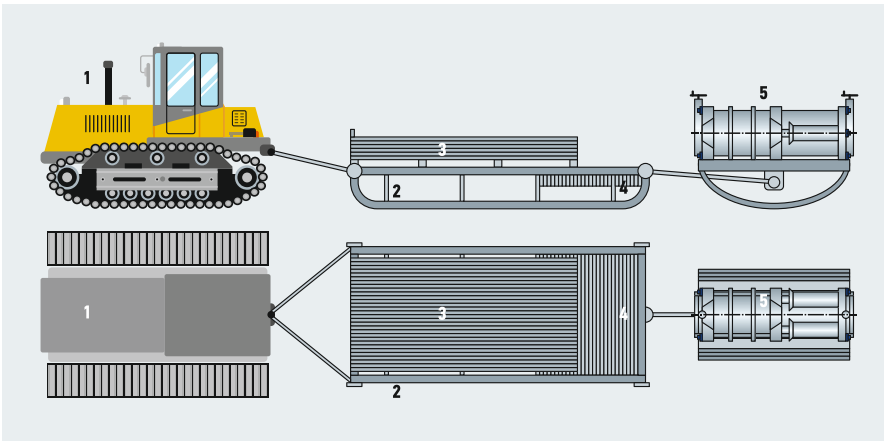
Мобильная линия для монтажа трубопровода из труб из ВЧШГ с К-ПС (1 — трактор; 2 — сани; 3 — стеллаж для труб; 4 — корзина; 5 — установка для сборки соединений)
